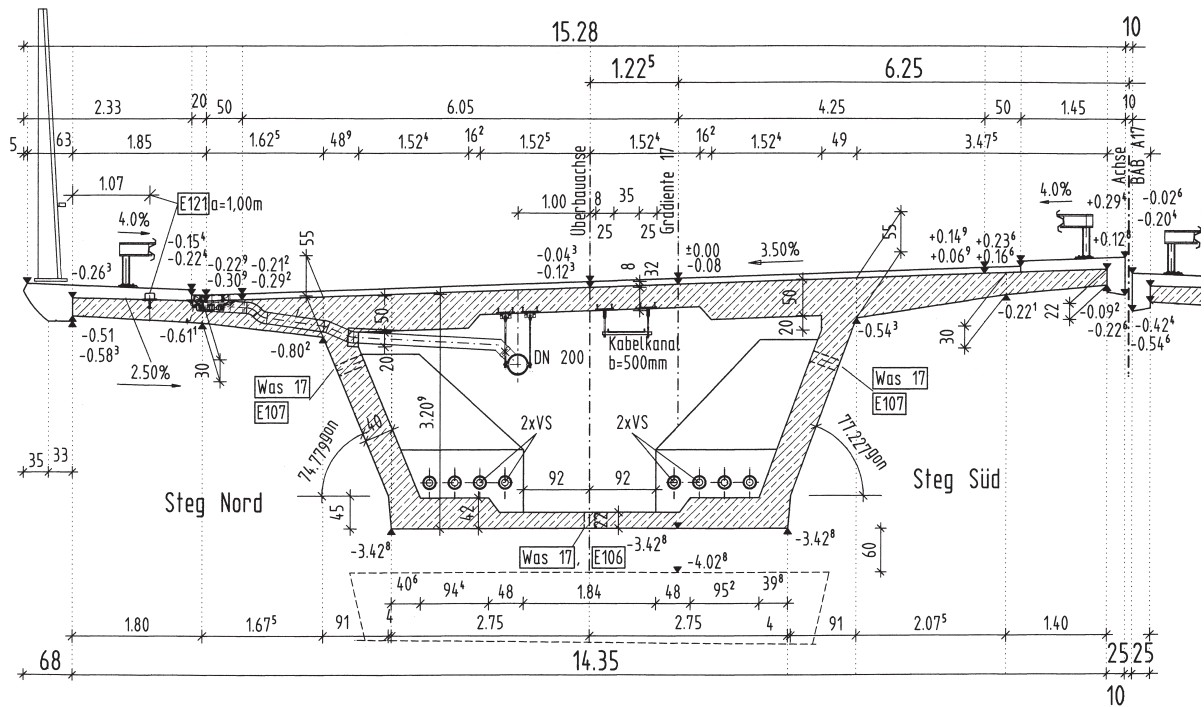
Gebergrundtalbrücke – Überbauquerschnitt
